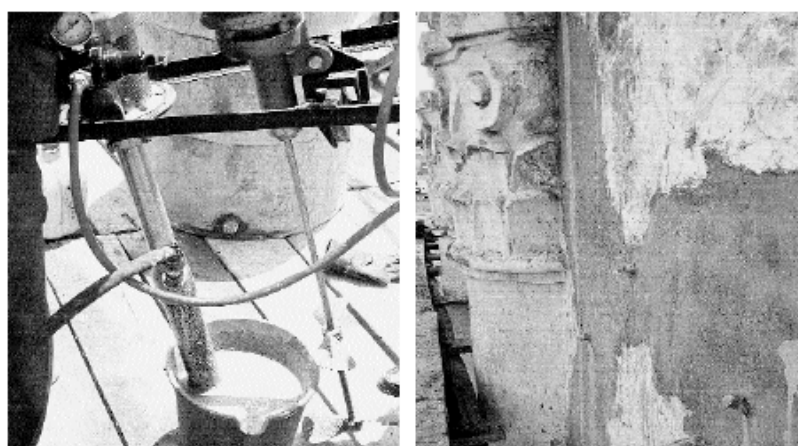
Morteros de consolidación (Der), Lechada en fisuras (Izq)
